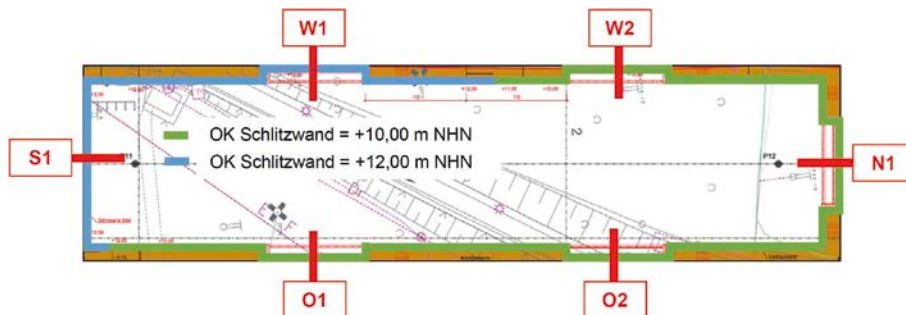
Bemessungsschnitte entlang der Baugrubenumschließung
